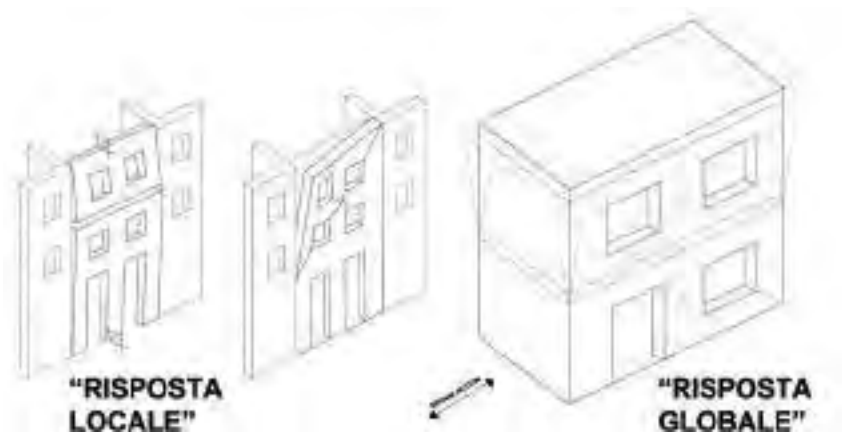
Distinzione tra risposta locale e globale di danneggiamento dell'edificio in muratura.
